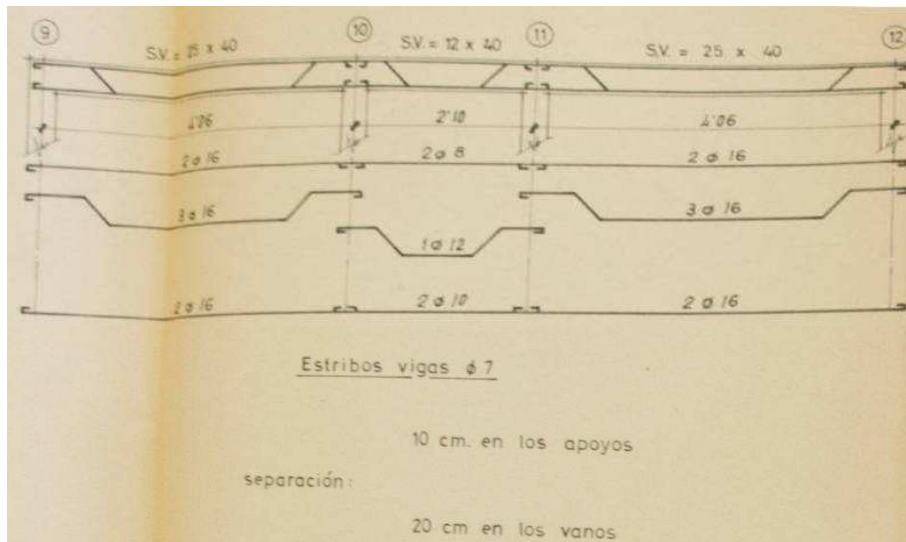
Despiece de armado de vigas, Edificio ficha 195C.021, 1966.
